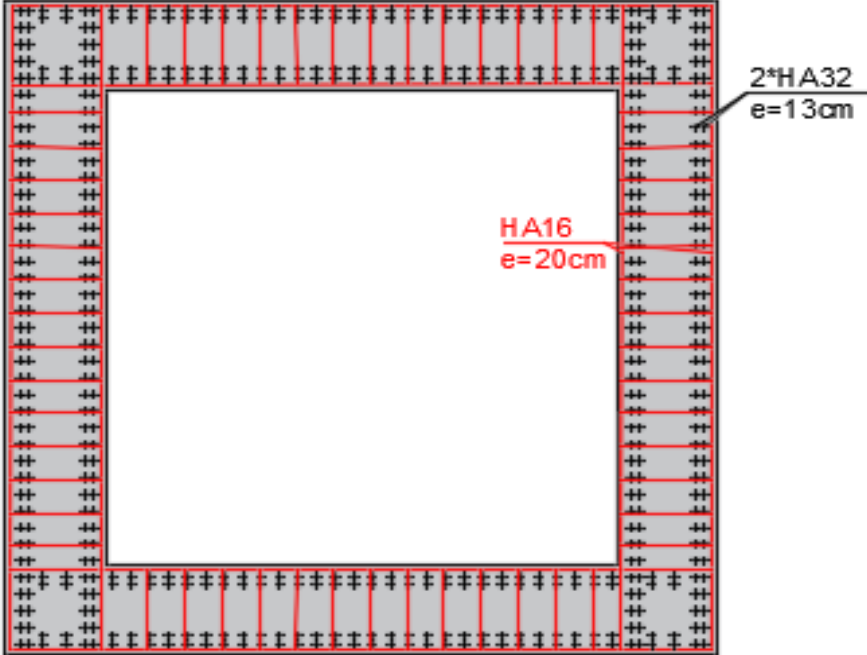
coupe transversal qui montre le ferrailage de la pile 01
